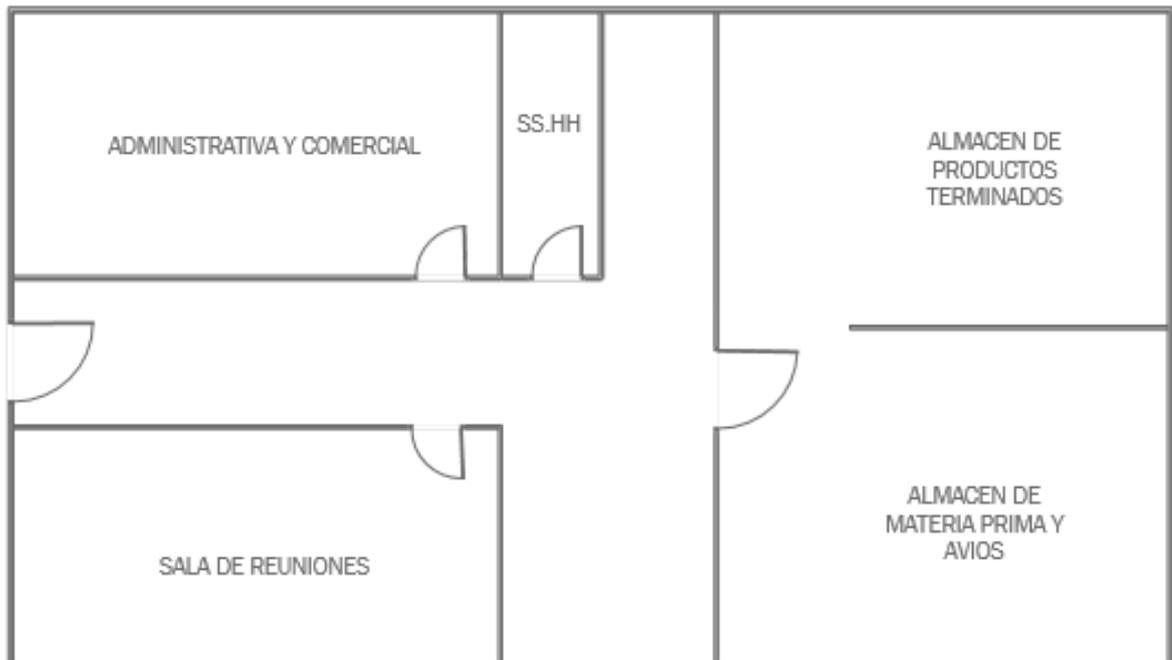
Plano del primer piso. *Fuente:* Elaboración propia.
